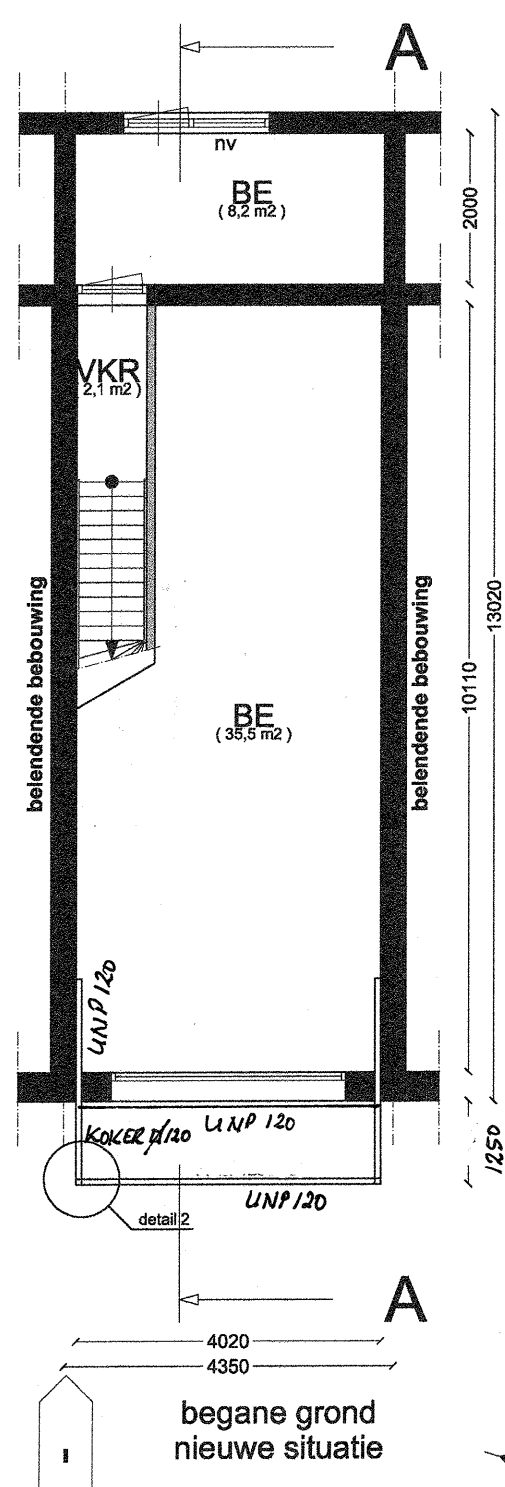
en detail 3 zijn vervangen door de later ingediende details met betrekking tot de balustrade
